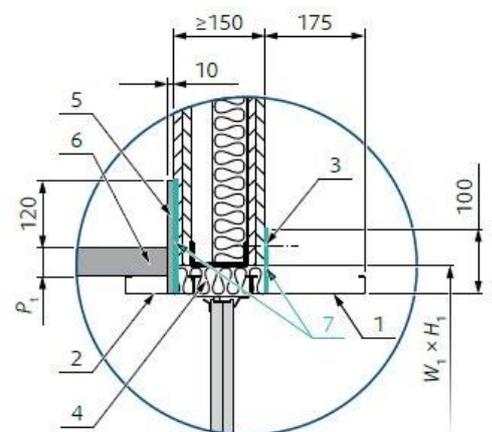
(EI90S) Sezione trasversale di Installazione soft crossing in parete flessibile
